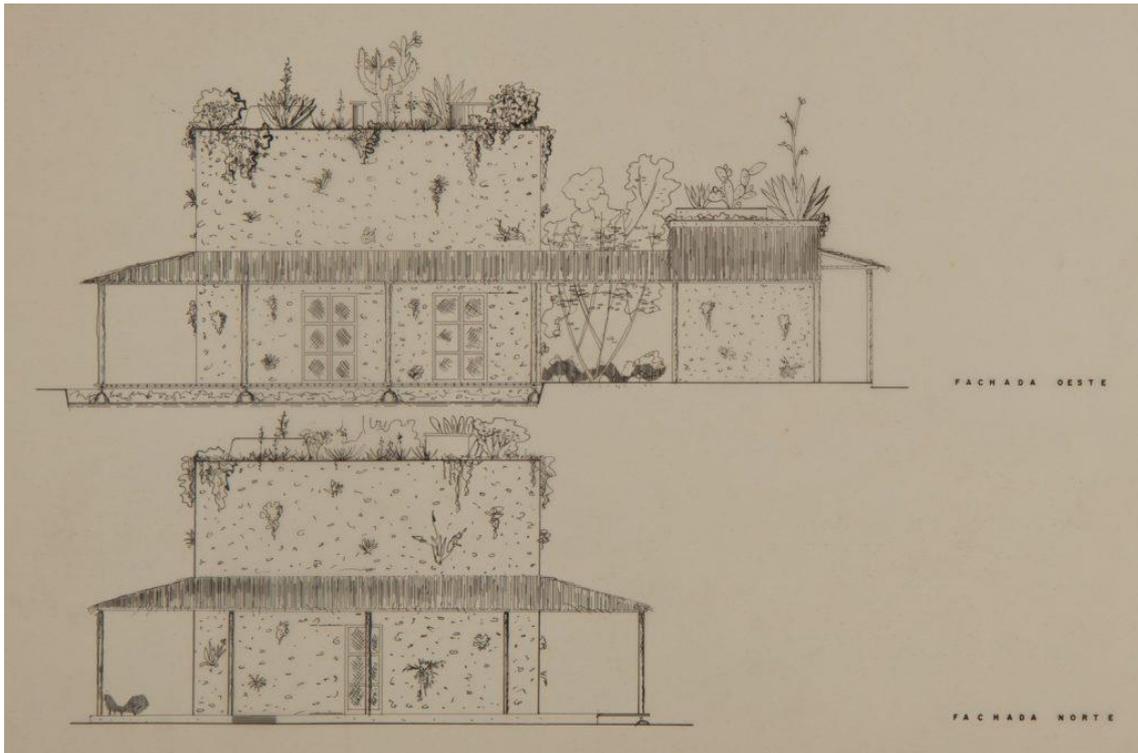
fachada norte y oeste de la Casa Valéria P. Cirell, archivo Instituto Bardi
